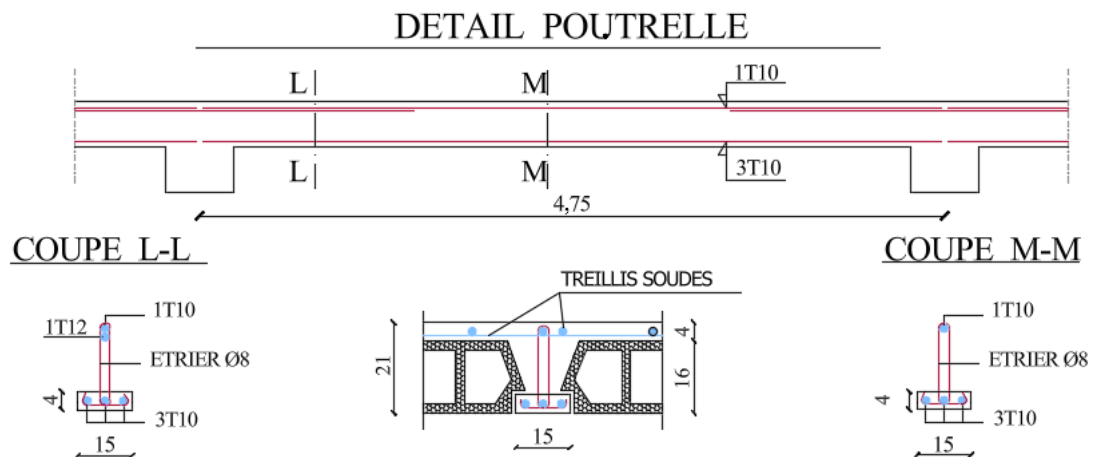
Ferrailage de poutrelle sur travée et appui .
